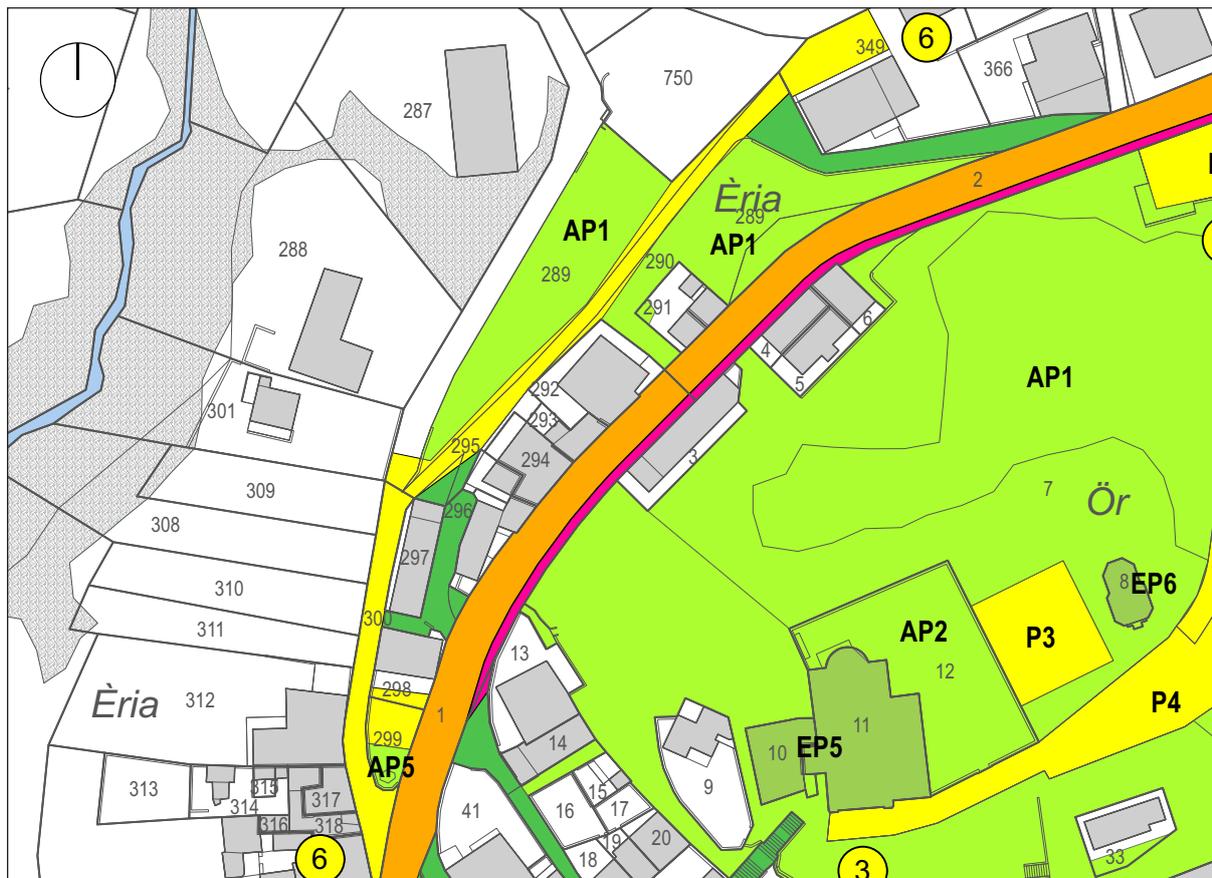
Estratto Piano del Traffico e degli AP-EP (Sez. Breno), variante di PR | 1:1'250
